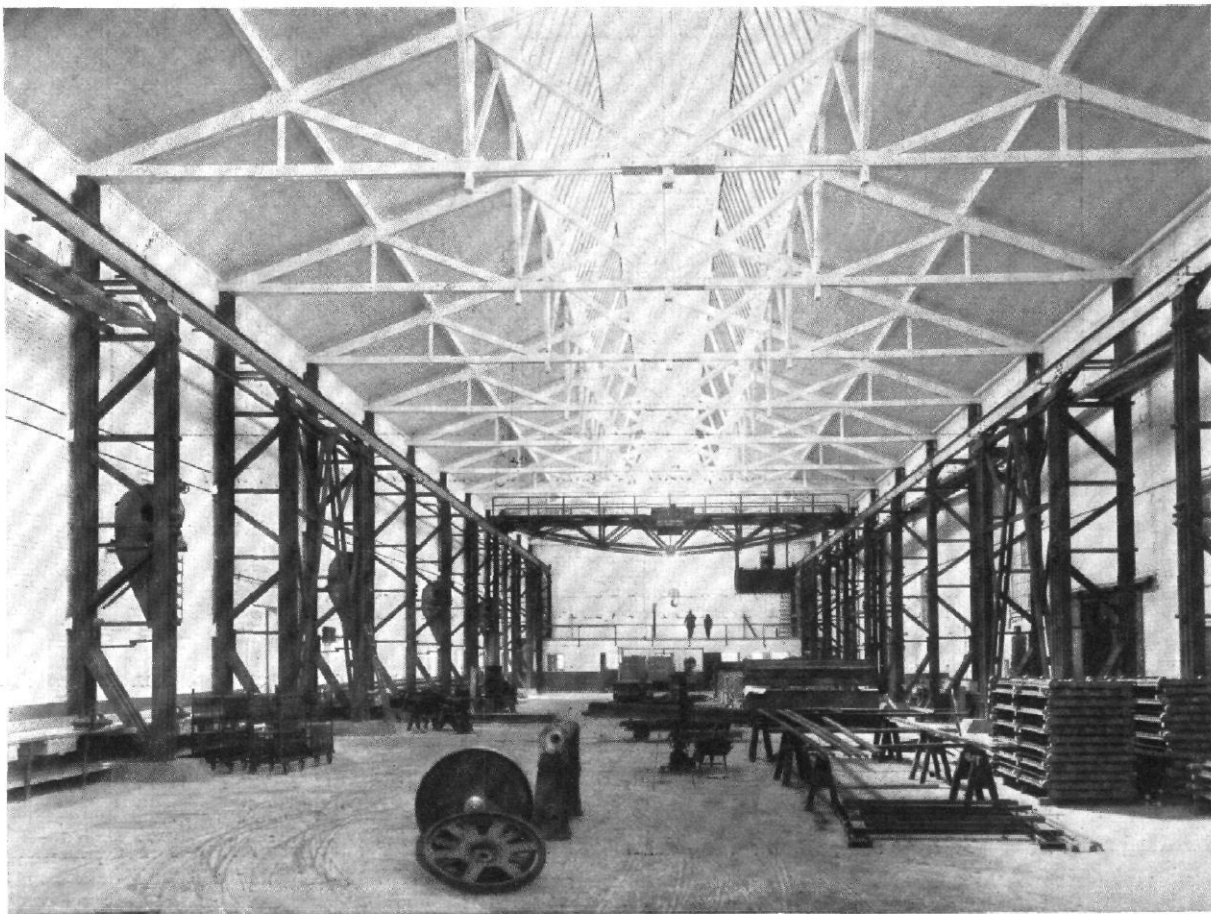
| Großfabrikhalle Werner & Pfeiderer, Feuerbach, Stuttgart | Das Innere der Halle in Holzkonstruktion. Decken, Wände und Dachkonstruktion weiß gestrichelt. Die Ständerkonstruktionen in grauem Anstrich, die Laufschiene des Krans rot Mennig | Es zeigt sich die Lichtreflexwirkung des oberen Abschlusses, die heller ist als die Glasflächen selbst | Architekt: Paul Schmitthemer, Stuttgart
